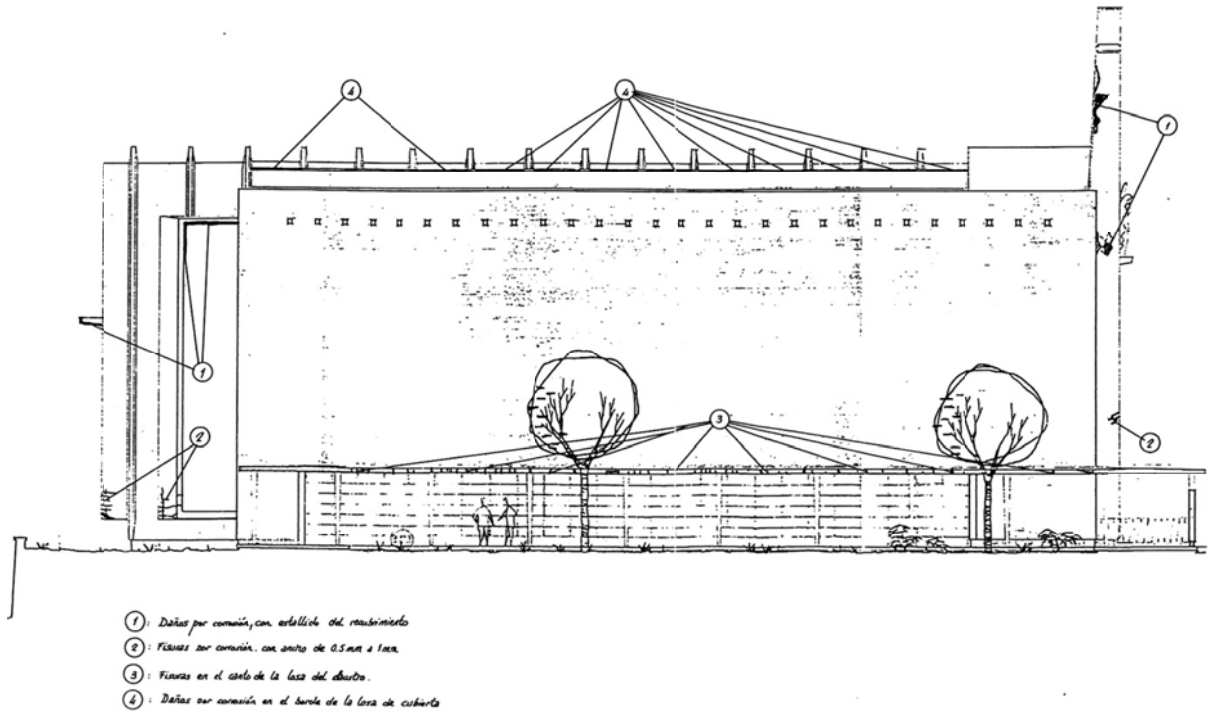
Croquis daños Fachada Norte. (Fernández, J. 1999)
